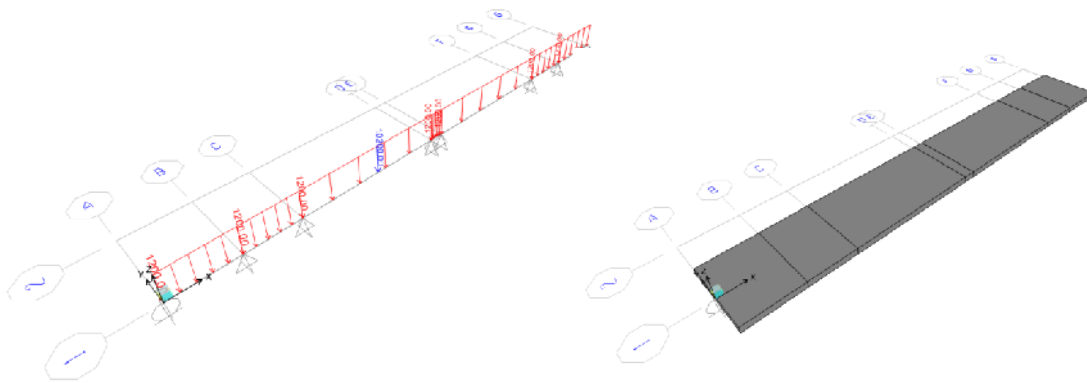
Modelo Estructural de Viga Continua con Carga LL (Carga Equivalente) Franja de Losa L=20m, e=25cm (Ancho =3.05m)
